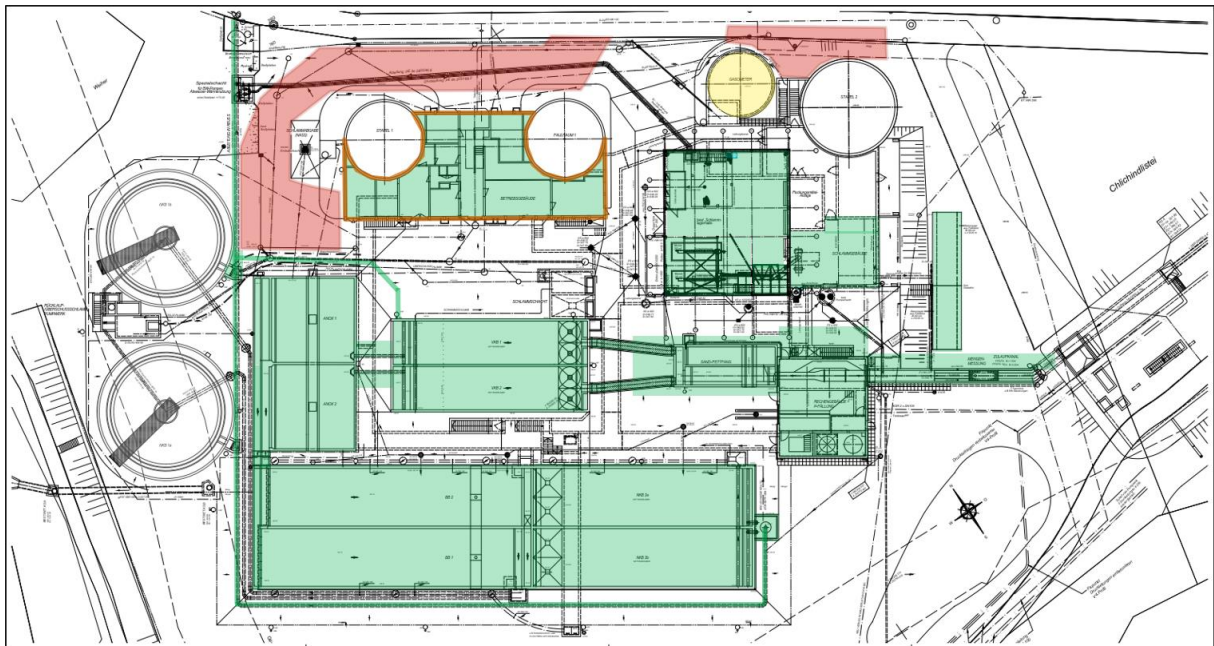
Etappe 3.2 Rückbau Faulung und Sanierung Betriebsgebäude
